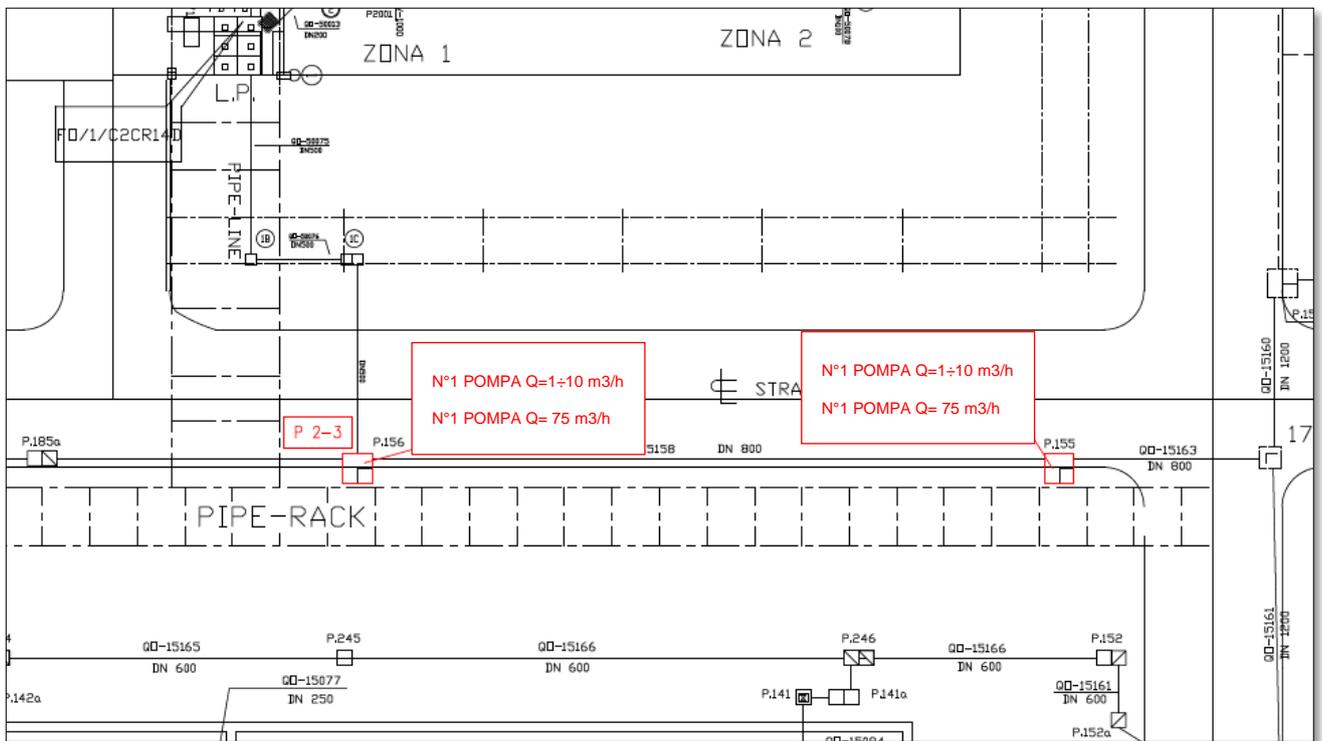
Dettaglio posizionamento planimetrico delle nuove pompe presso scarico P 2-3.
